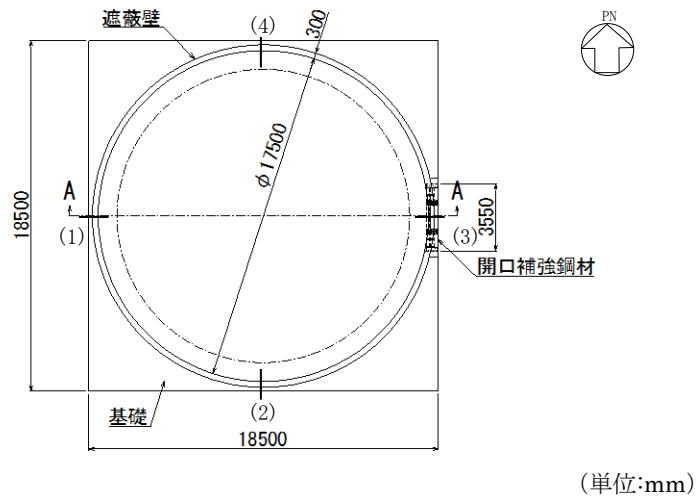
トーラス水受入タンク遮蔽壁 平面図
